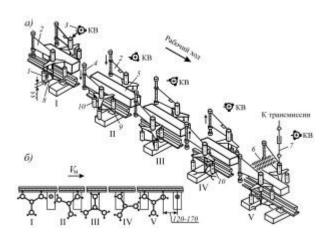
Работа моторного гайковерта: последовательность рабочих позиций (а) и положения искателя (б): 1 – трехшпиндельный гайуоверт; 2 – водило; 3 – упор с конечным выключателем КВ; 4 – стойка водила; 5 – направляющая горизонтальная линейка; 6 – стяги-вающий комплект пружин; 7 – карданный вал привода шпинделя; 8 – искатель; 9 – гайка скрепления; 10 – шпиндель гайковерта
